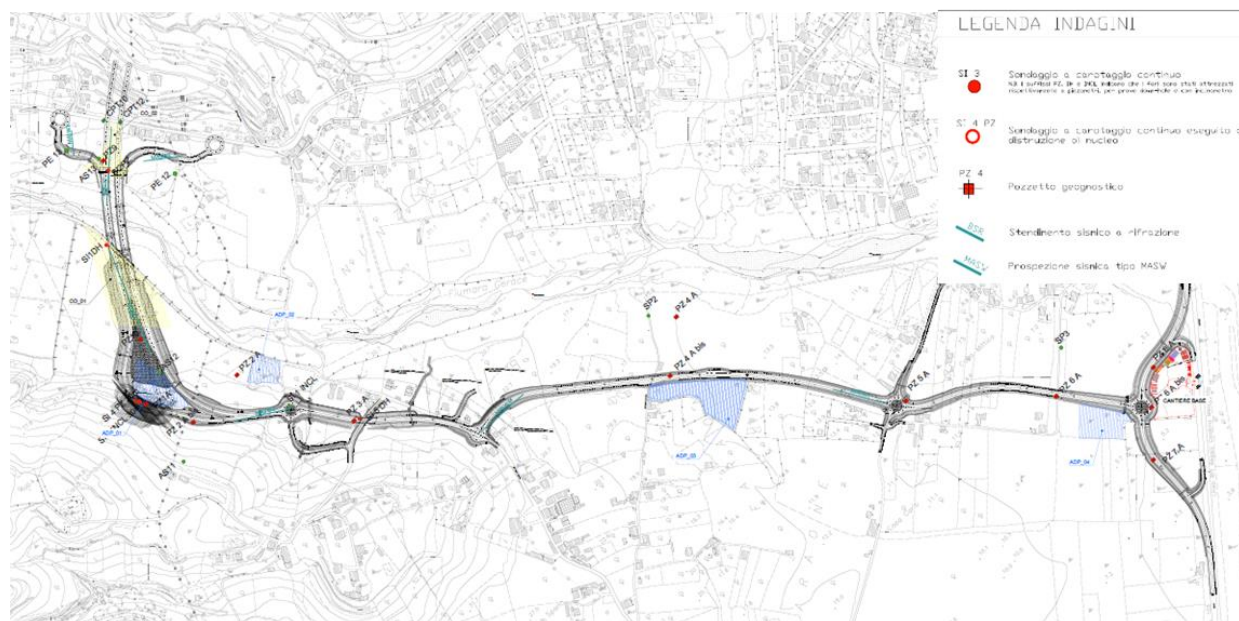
Planimetria con ubicazione delle indagini di caratterizzazione ambientale
